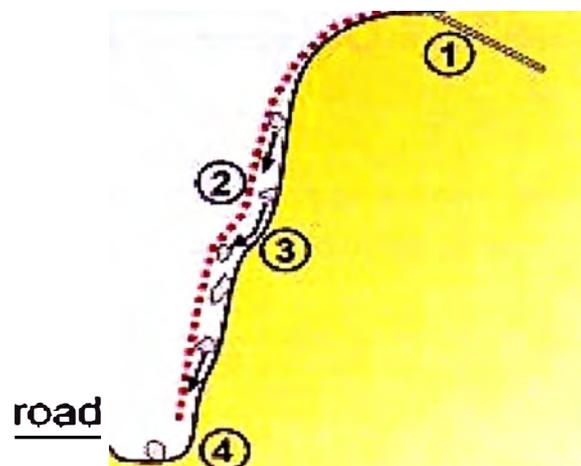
COLOCACION DE MALLA DE GUIADO DE PIEDRAS
